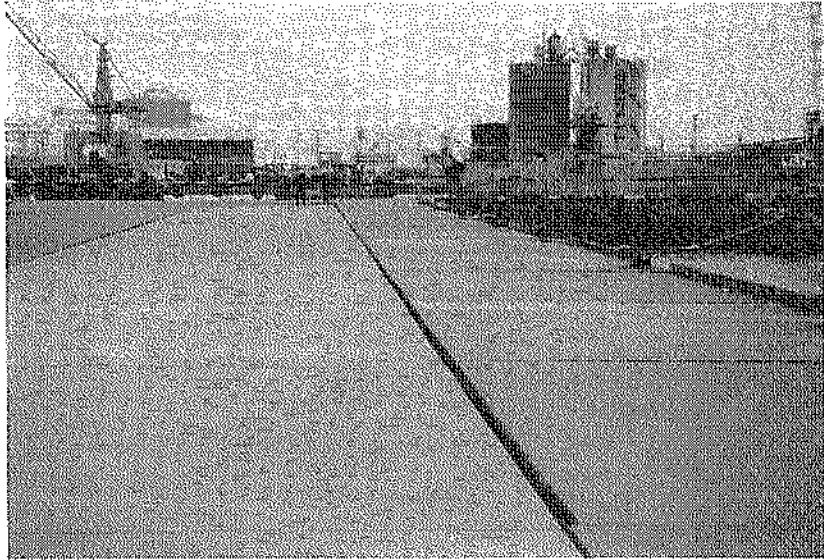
知人地区, ⑤物揚場(-4.0m)
